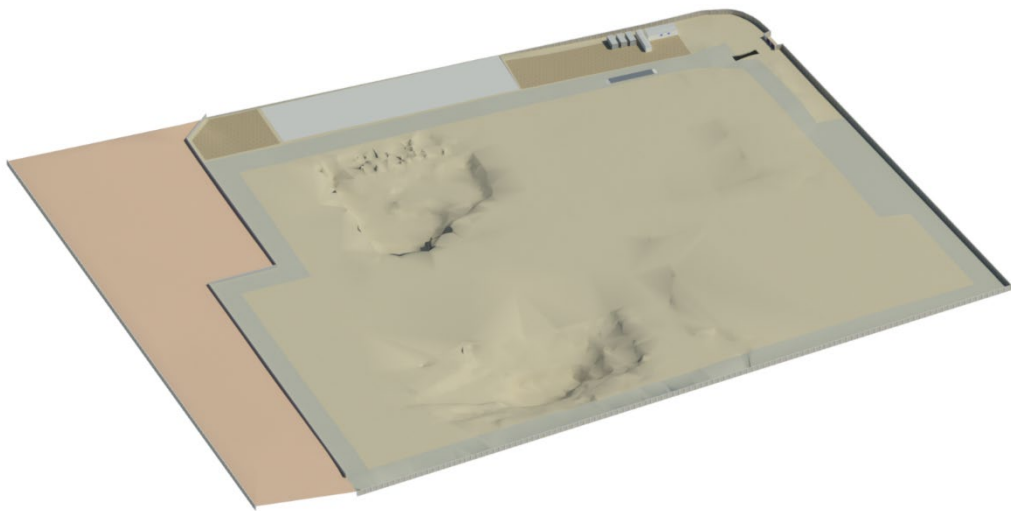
Planimetria di cantierizzazione, Tavola T9
